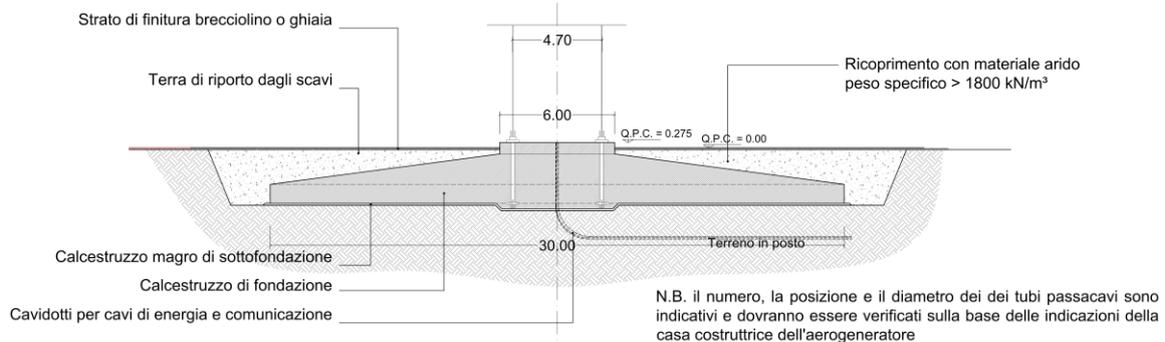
Pianta e vista della fondazione tipo dell'aerogeneratore
